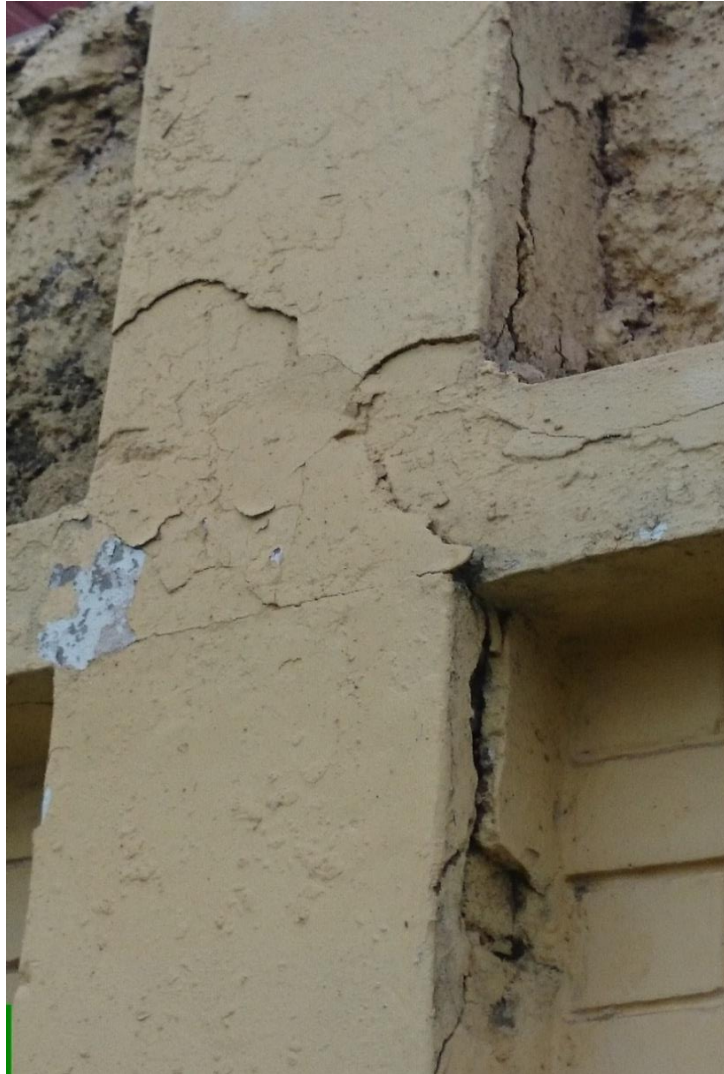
Fotografía que muestra las fisuras de una columna de la vivienda en estudio-Callao 2017.
